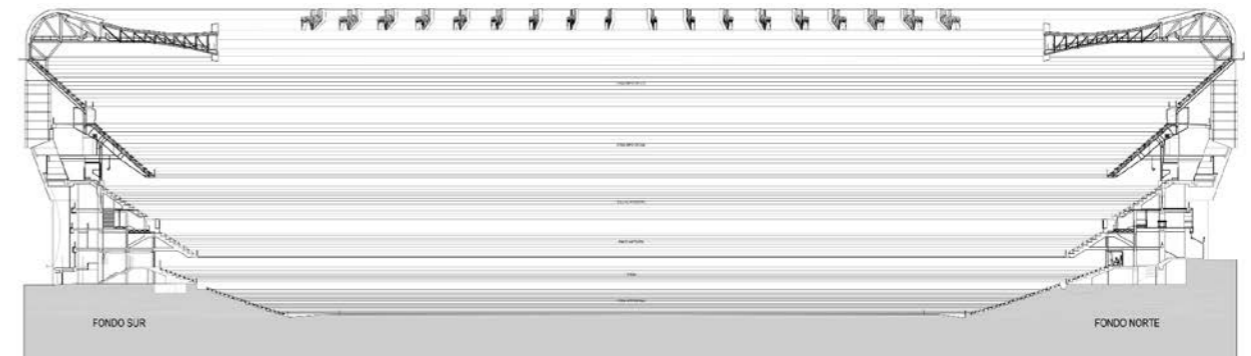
Sección longitudinal Norte-Sur del estadio tras la reforma de 2002.
